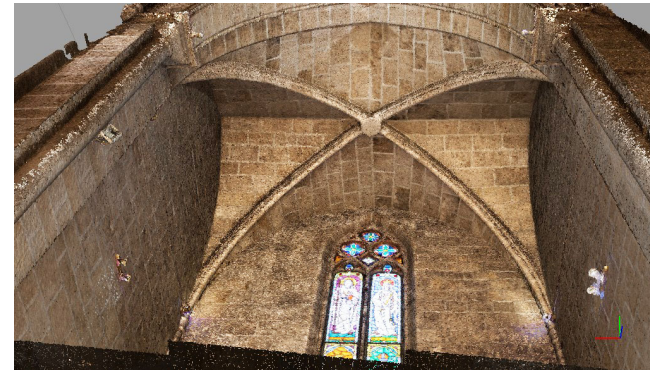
Vistas modelo 3D plementería realizadas con PhotoScan.
